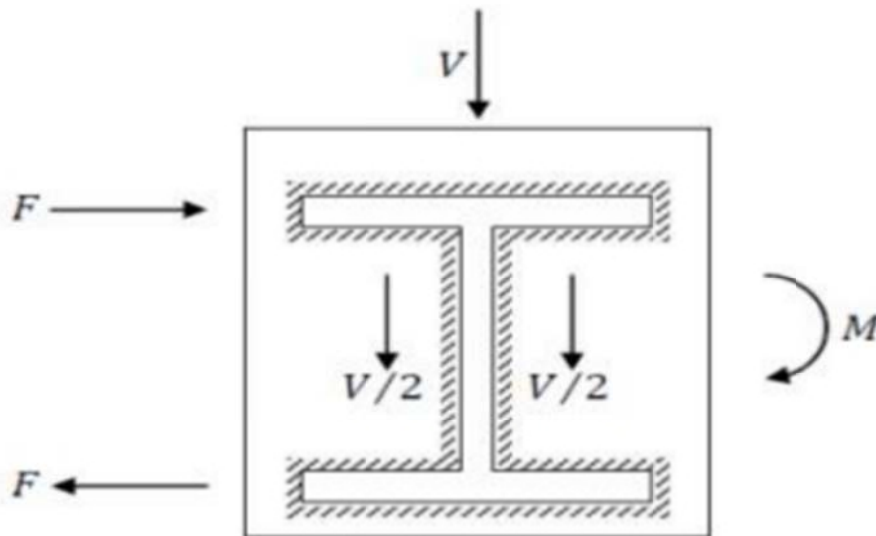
Assemblage par soudure poutre-platine .
